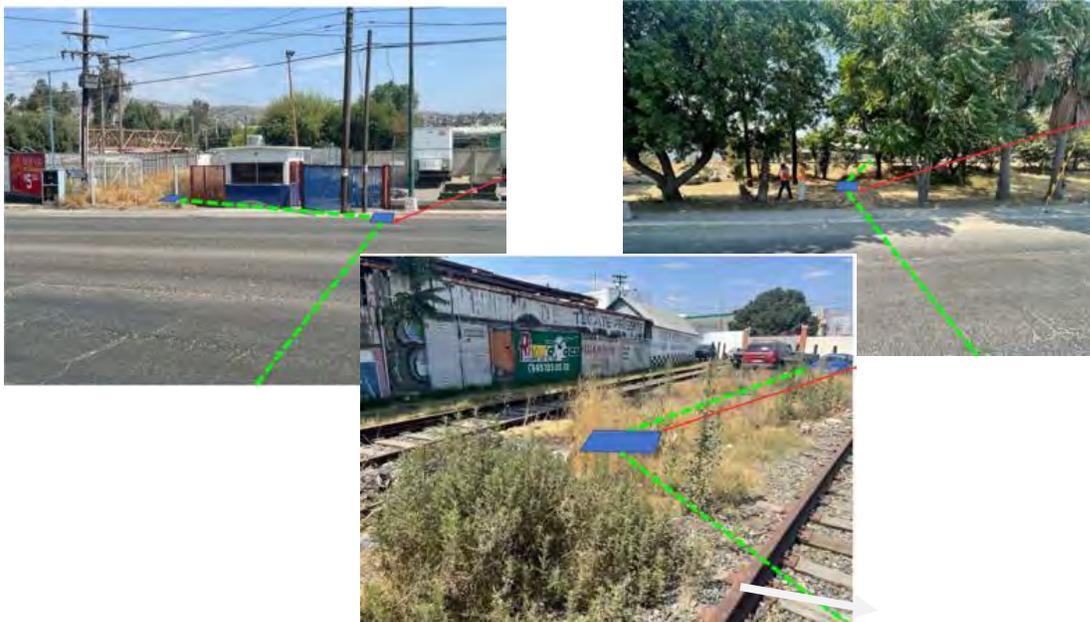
Plano B: Plano de reforestación del área de andador sección A
